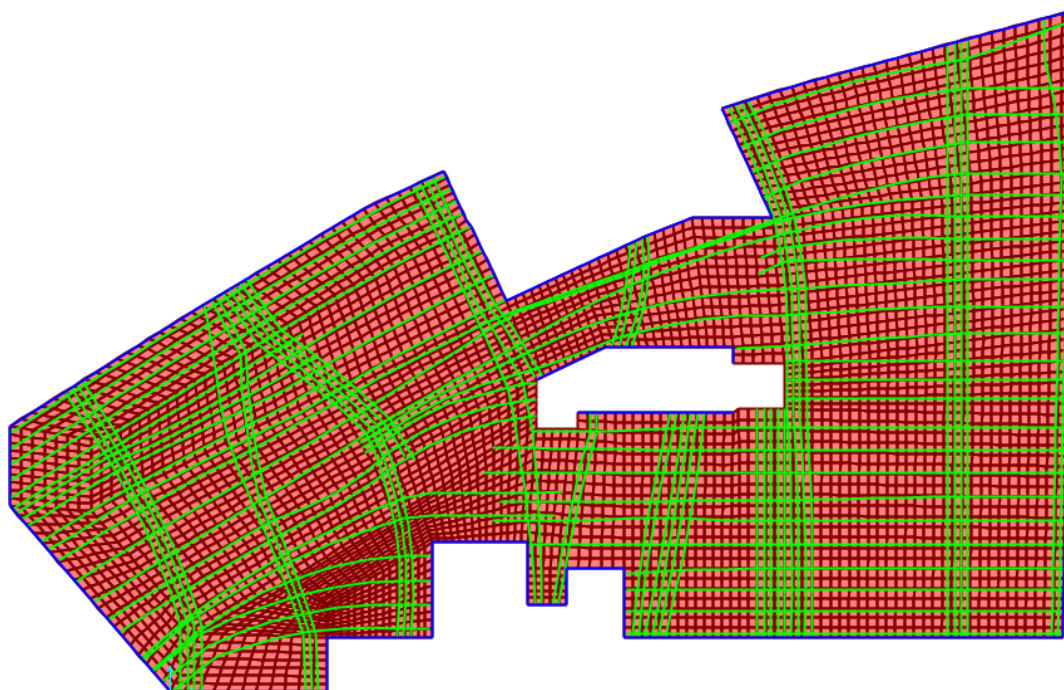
Laje discretizada e traçados dos cabos (SAP2000)
